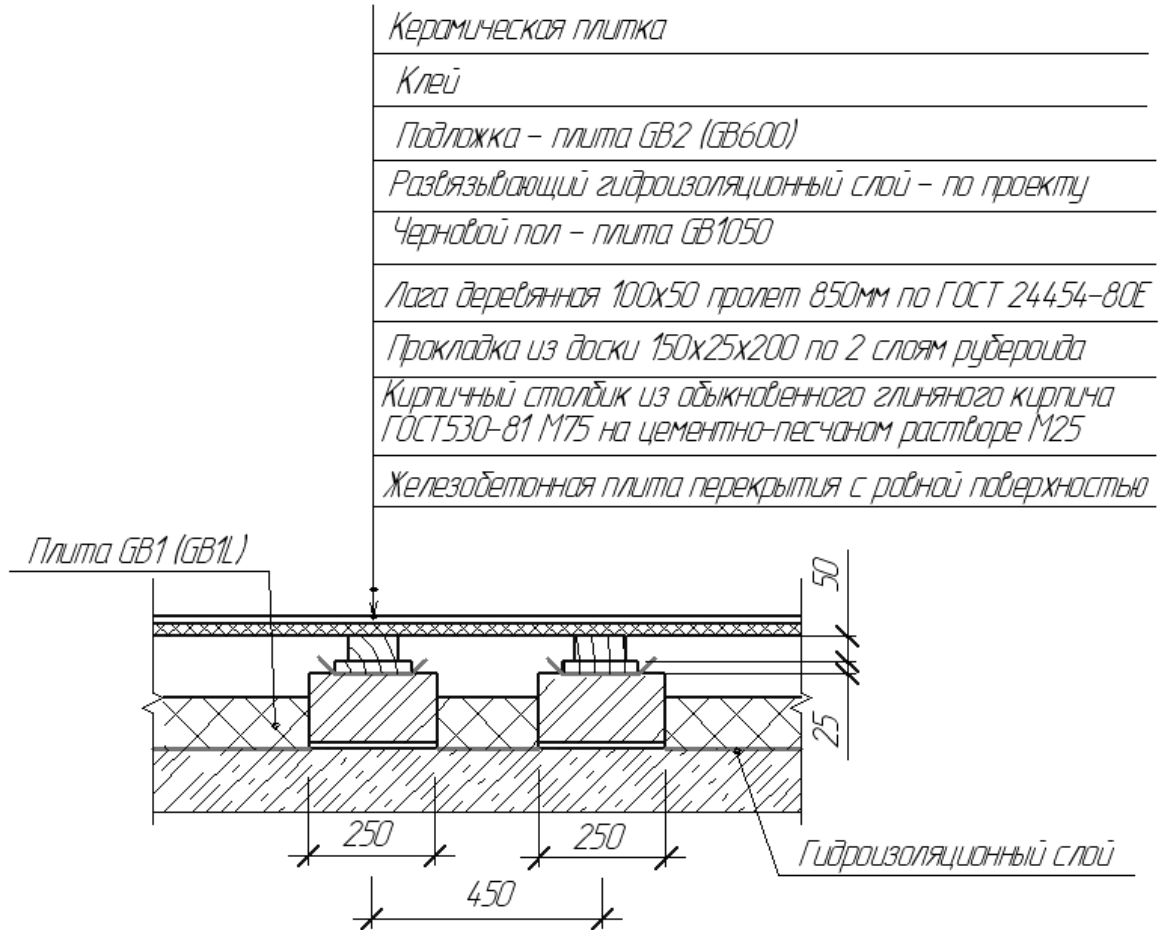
Конструкция плиточного пола по железобетонной плите перекрытия на кирпичных столбиках с утеплением с применением системы плит GREEN BOARD®
